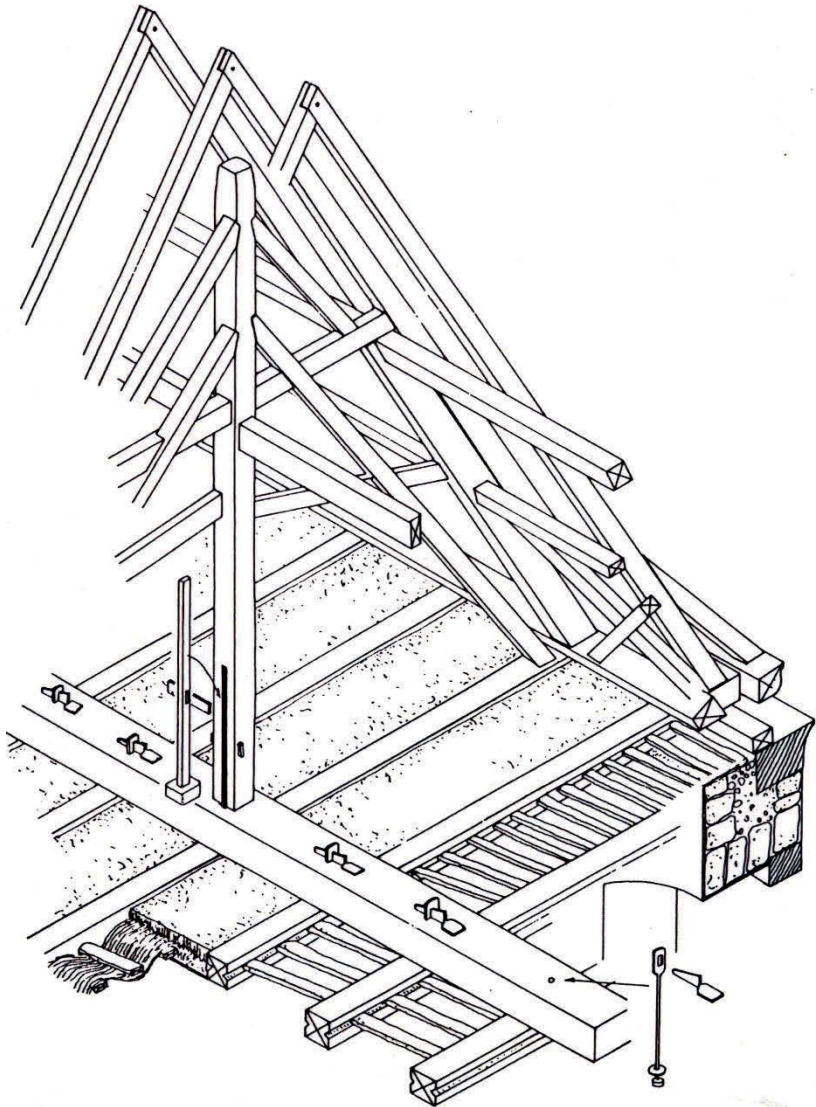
Dachkonstruktion mit Hängewerk über dem Rittersaal, 1604
